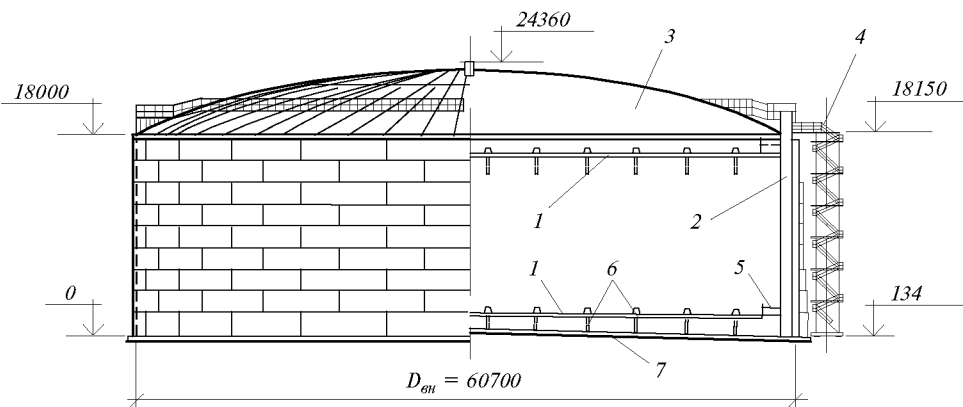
Вертикальный цилиндрический резервуар объемом 50 тыс.м<sup>3</sup> с понтоном
